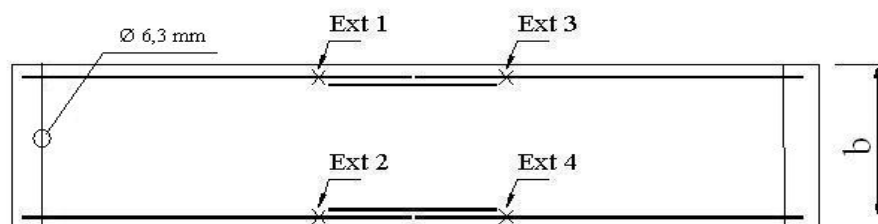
Vista em planta das vigas de cobrejunta.
